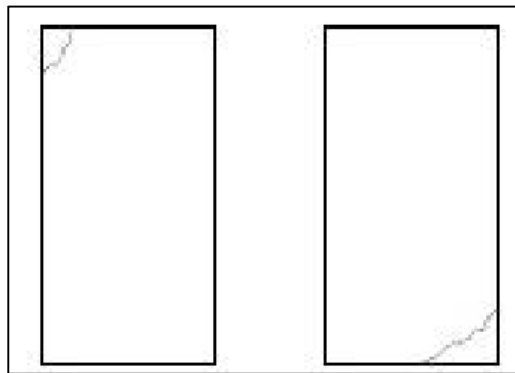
Fractura tipo V. Fuente. NTP 339.034 / ASTM C-39
